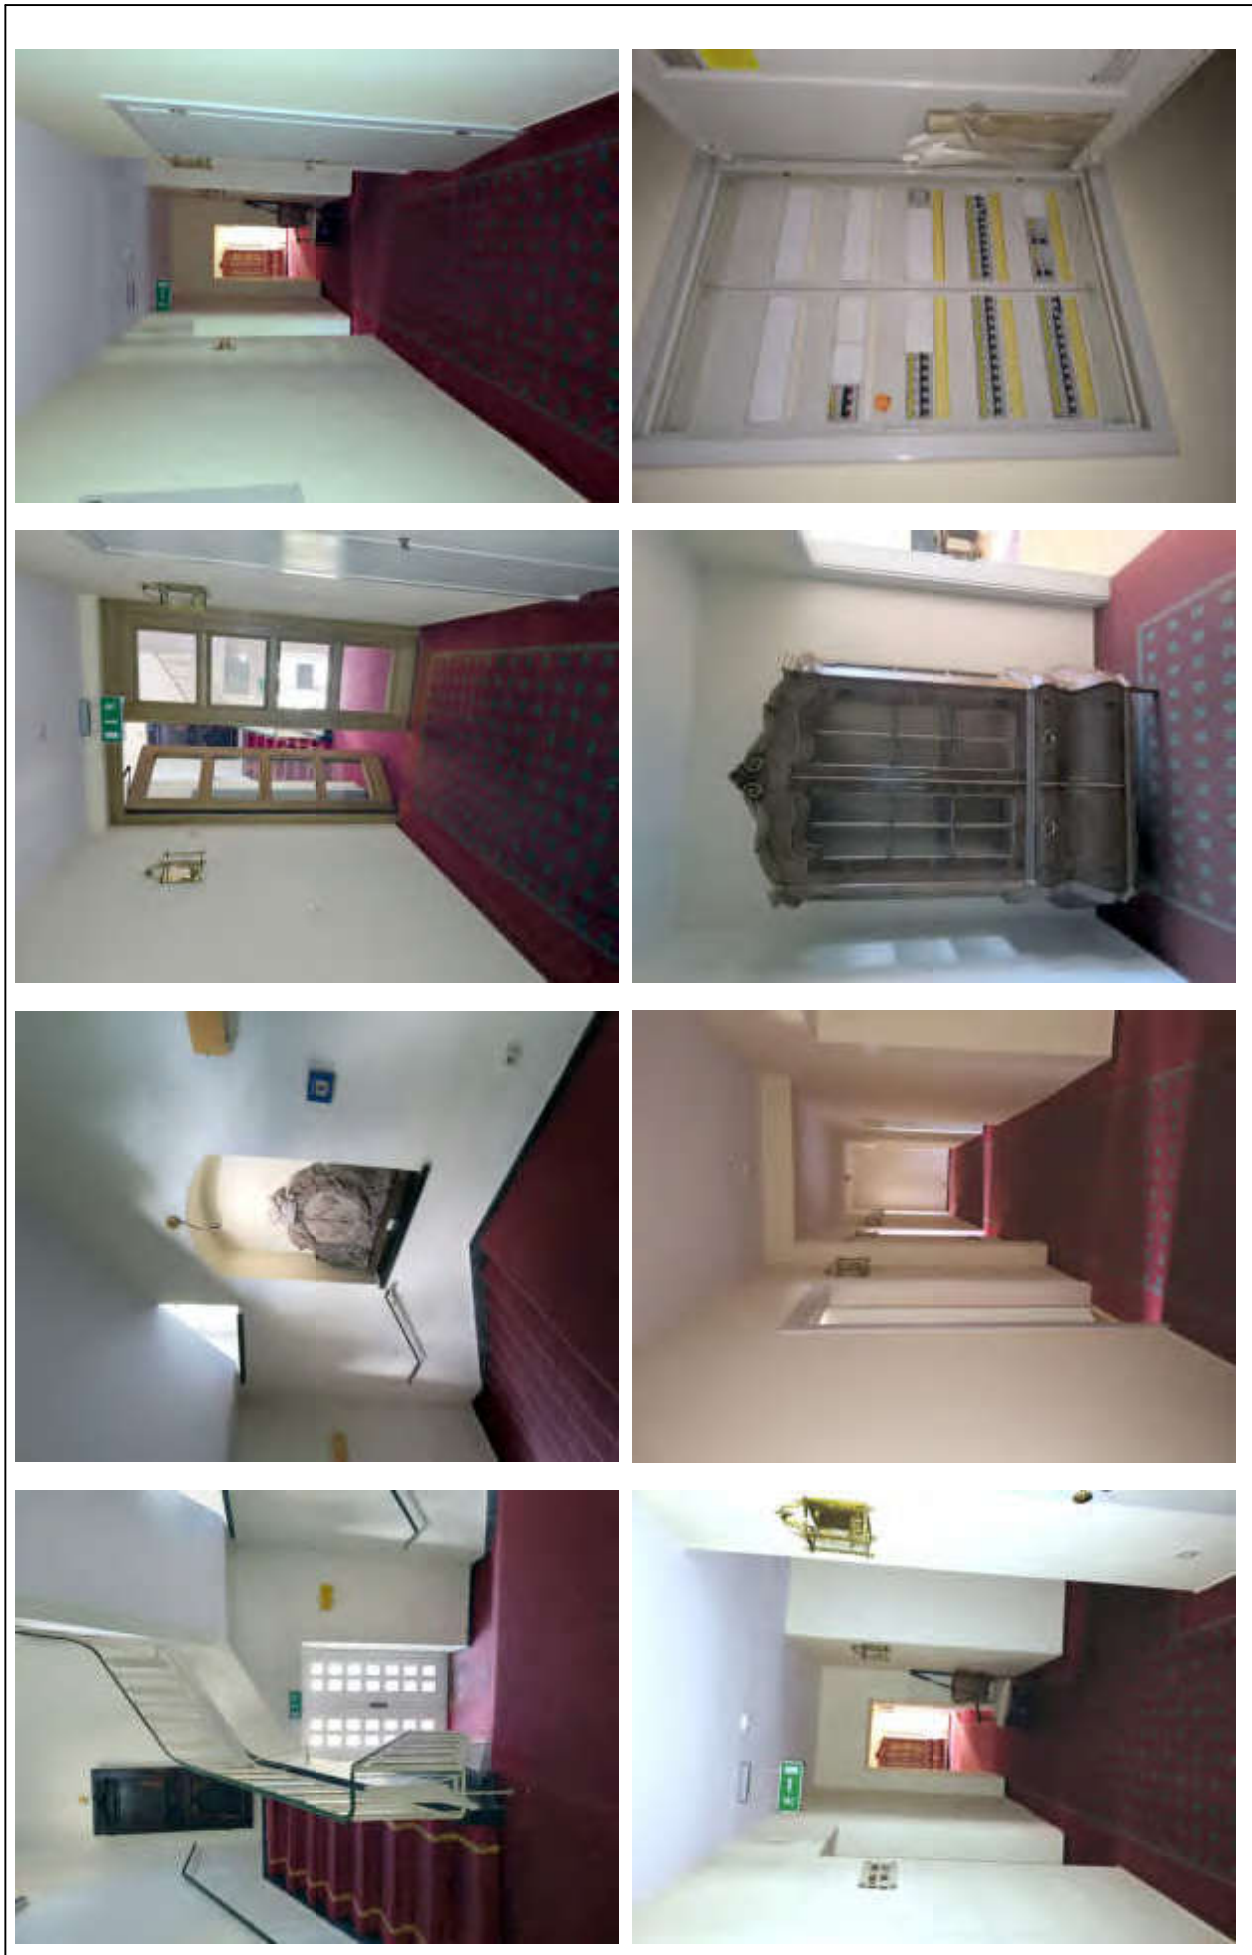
o Oben: Ansichten vom Erdgeschoss (Treppenhaus und Flure)
